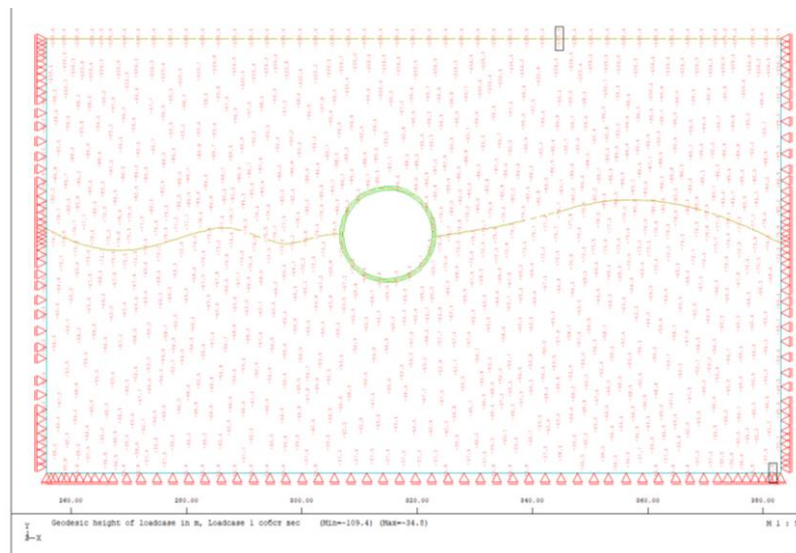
Нагрузки от давления грунта на конструкции тоннеля
